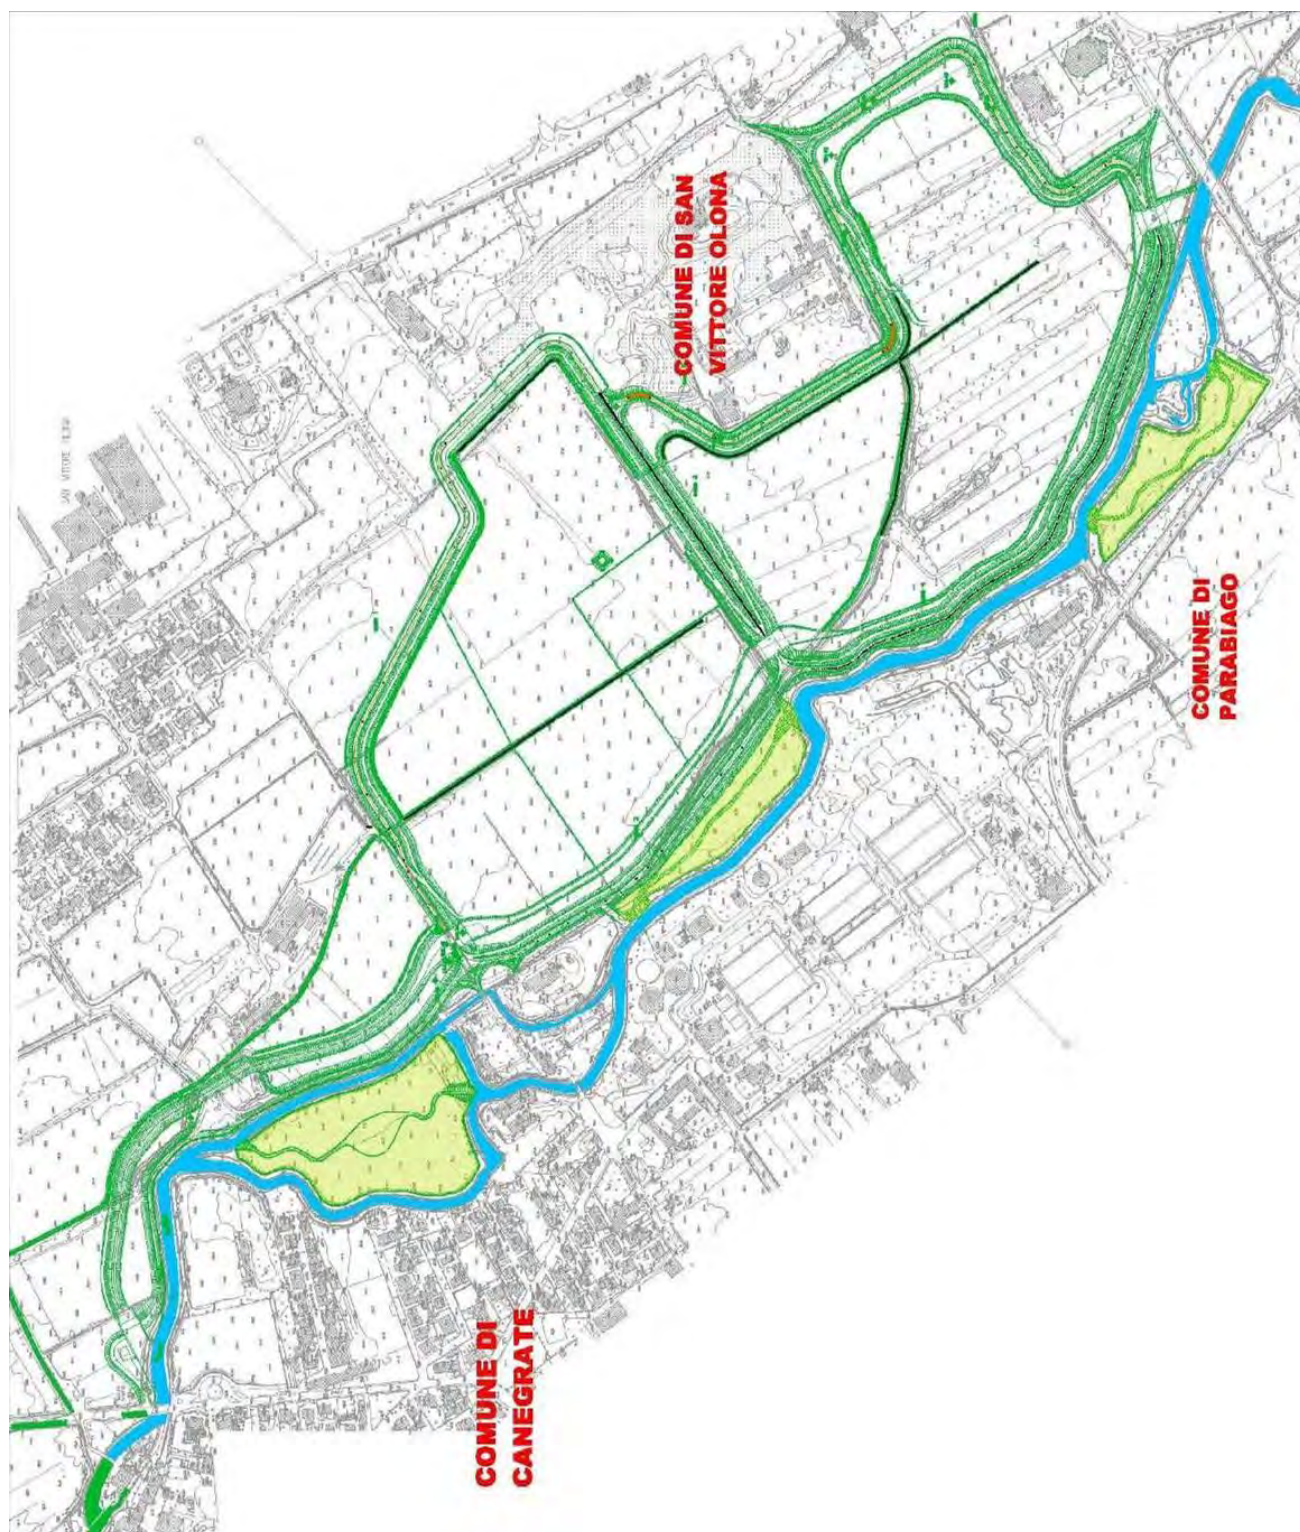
Progetto Esecutivo - primo lotto funzionale
